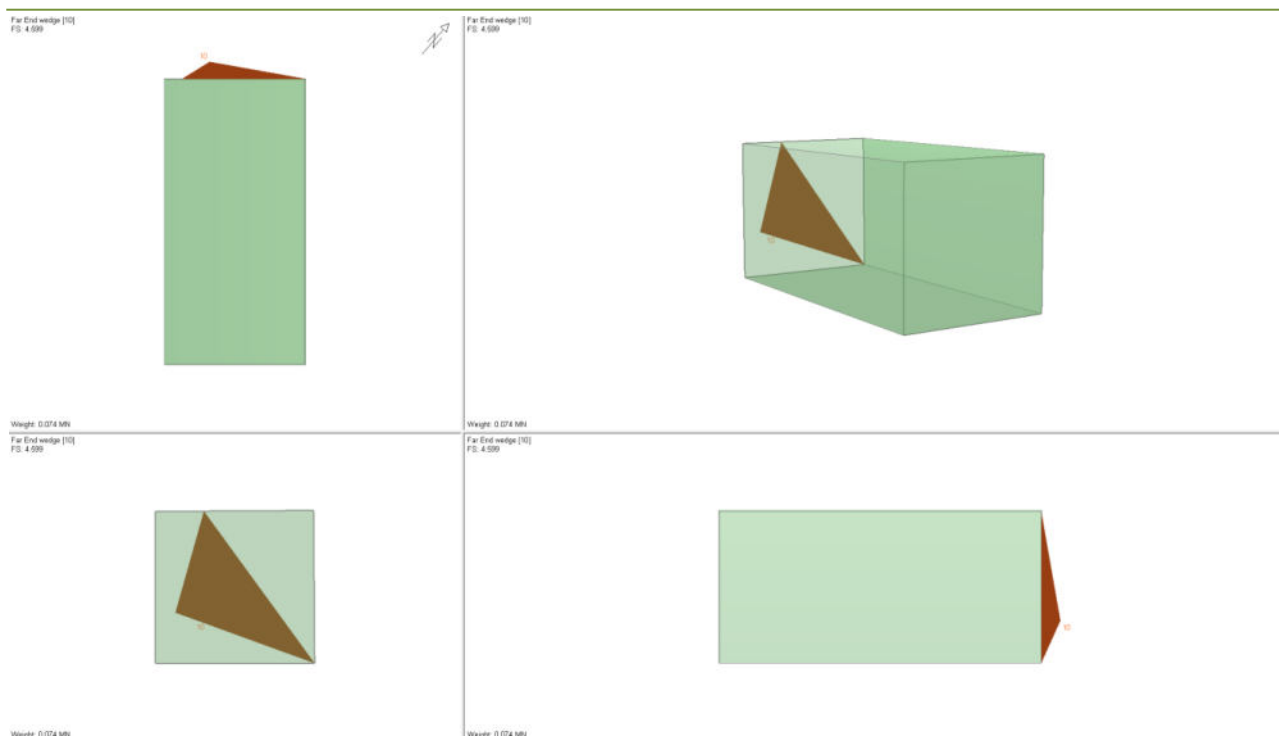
Cuneo su prospetto far-end - Galleria NW-SE.
